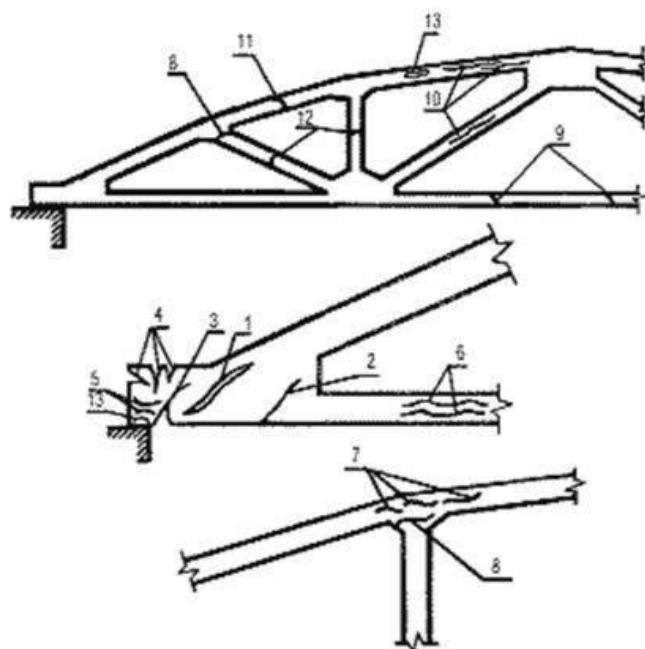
Схема основных участков разрушений предварительно-напряжённых железобетонных балок
